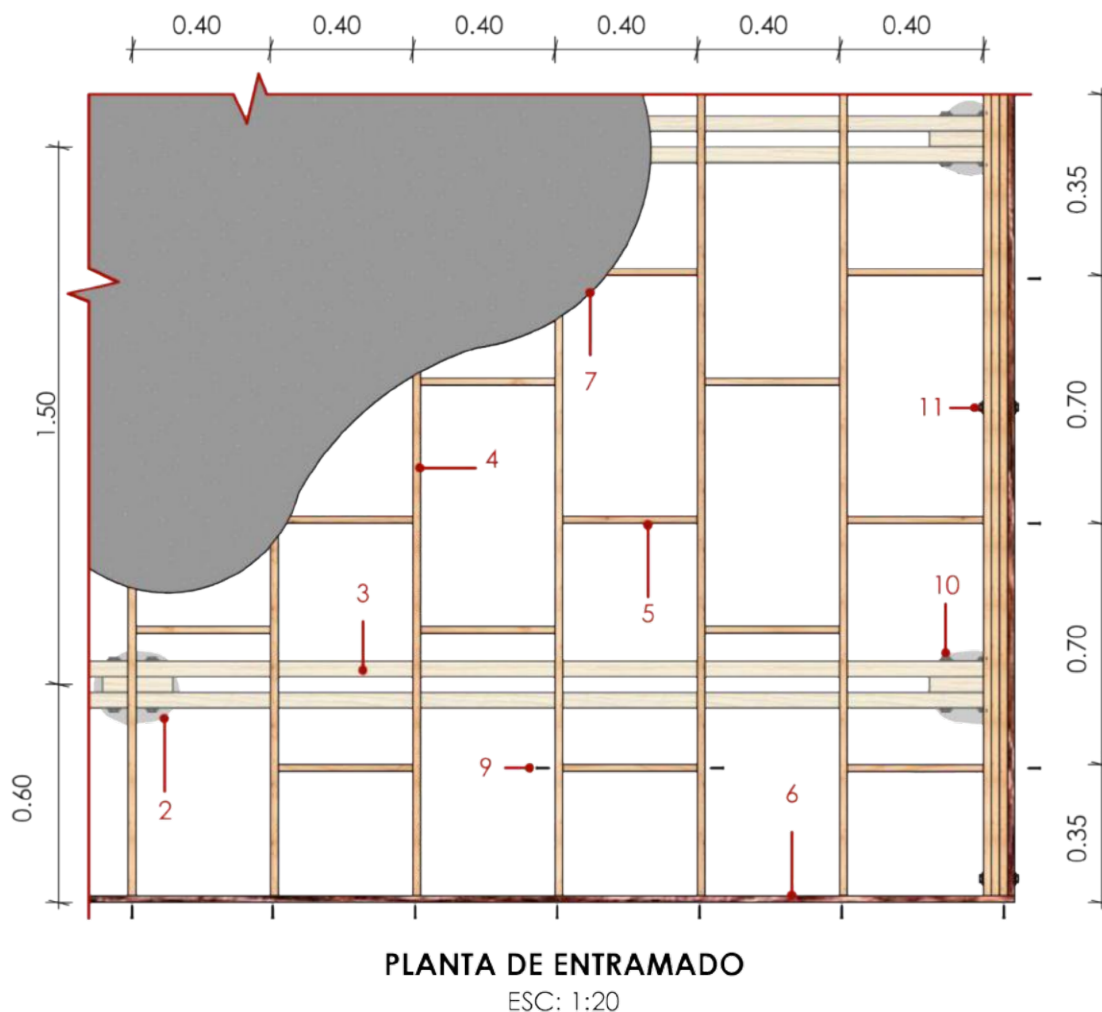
Configuración en planta de un módulo para el entramado de forjado.
